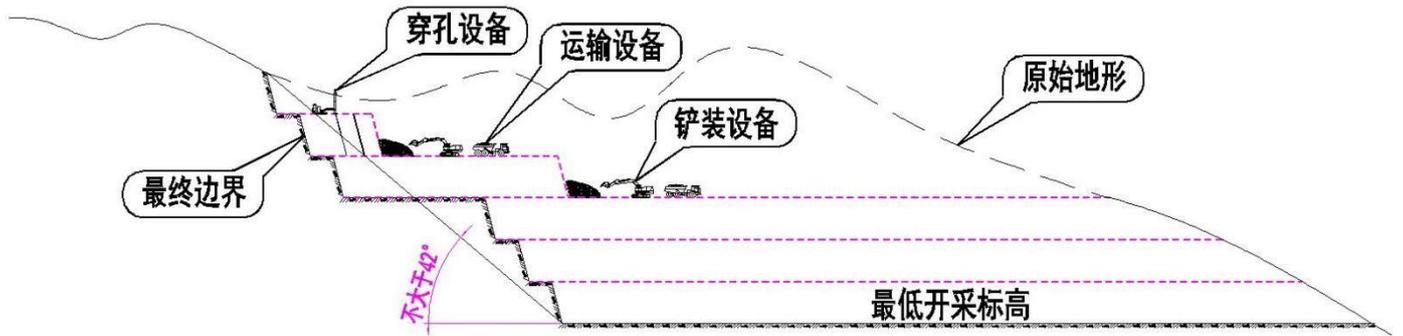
山脊型山坡露天矿开采剖面示意图
